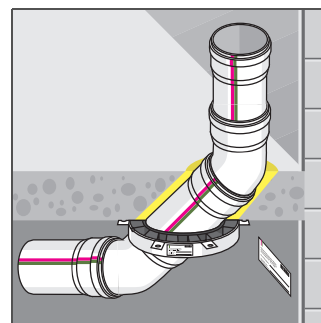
Угловая противопожарная манжета (только для накладывания на горизонтальное перекрытие)
